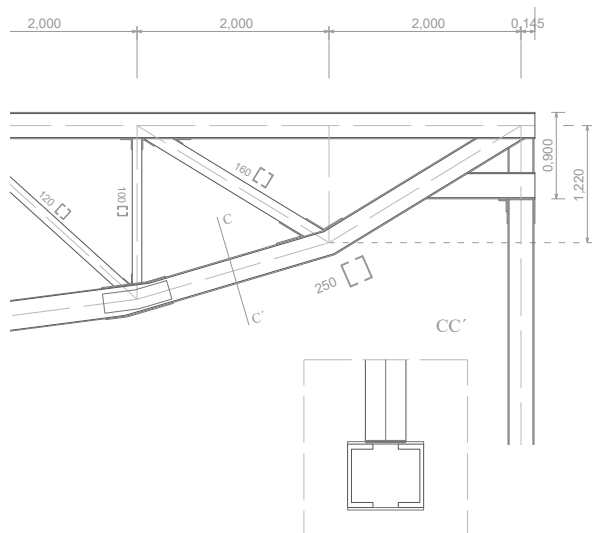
Detalle del alzado de la cercha del Gimnasio Maravillas y sección del cordón inferior.
